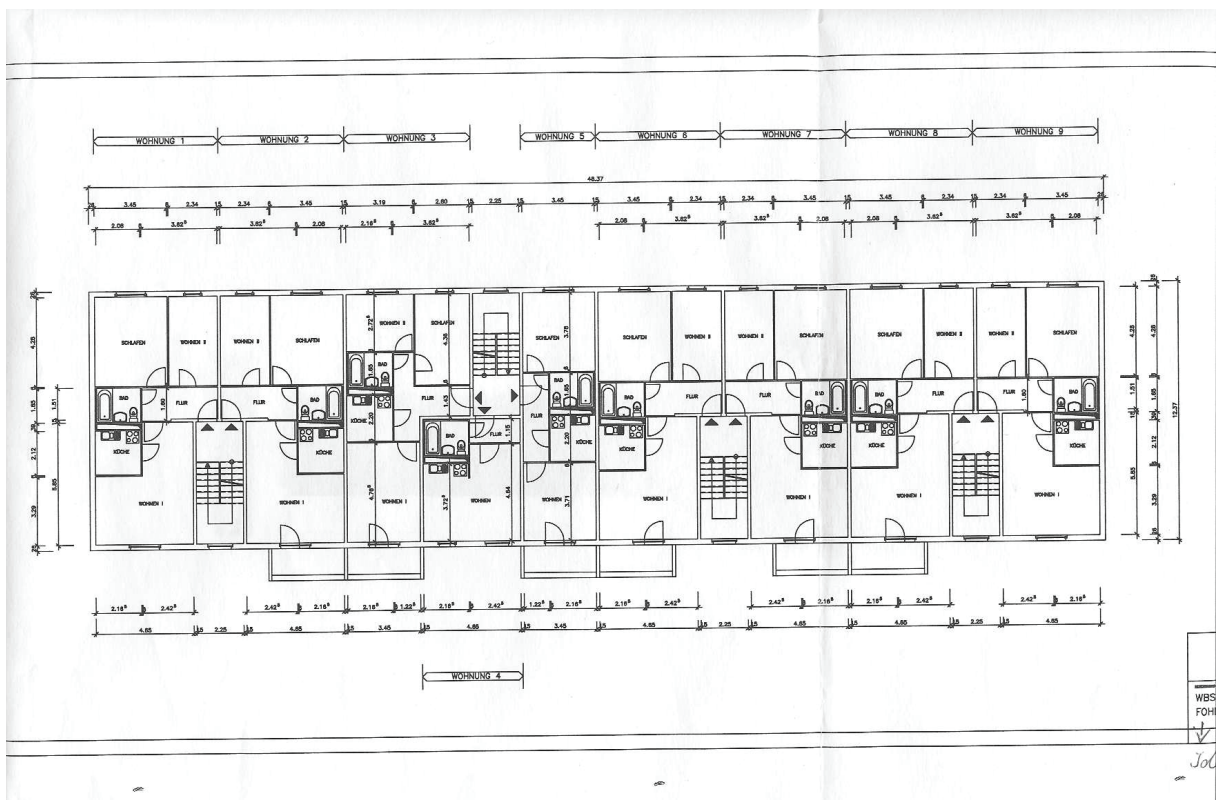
Grundrisse 1.Obergeschoss – Traberallee (Quelle: neuwoges)
